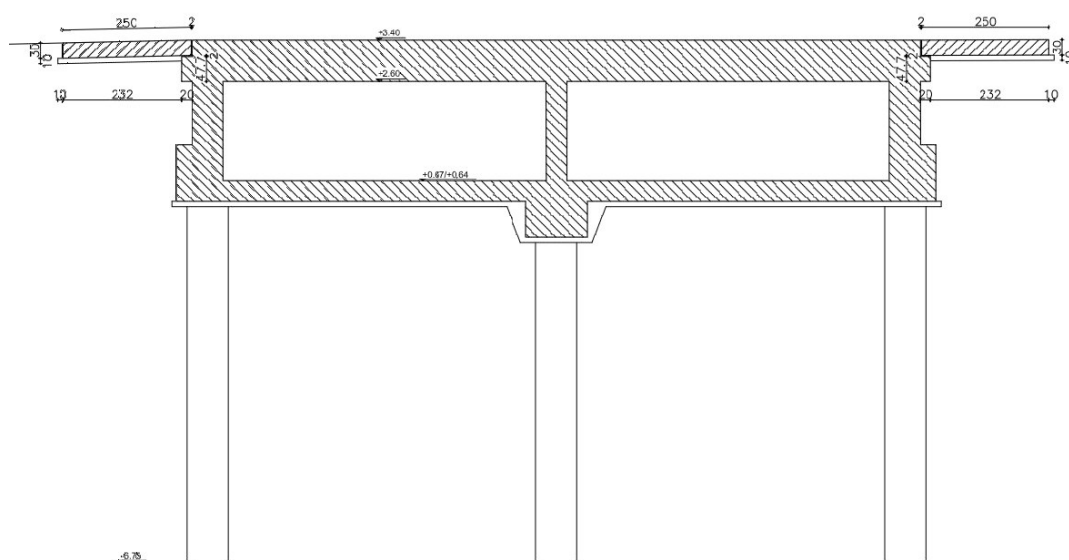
Modifiche strutturali del ponte su viale Pisano. Sezione Trasversale.
